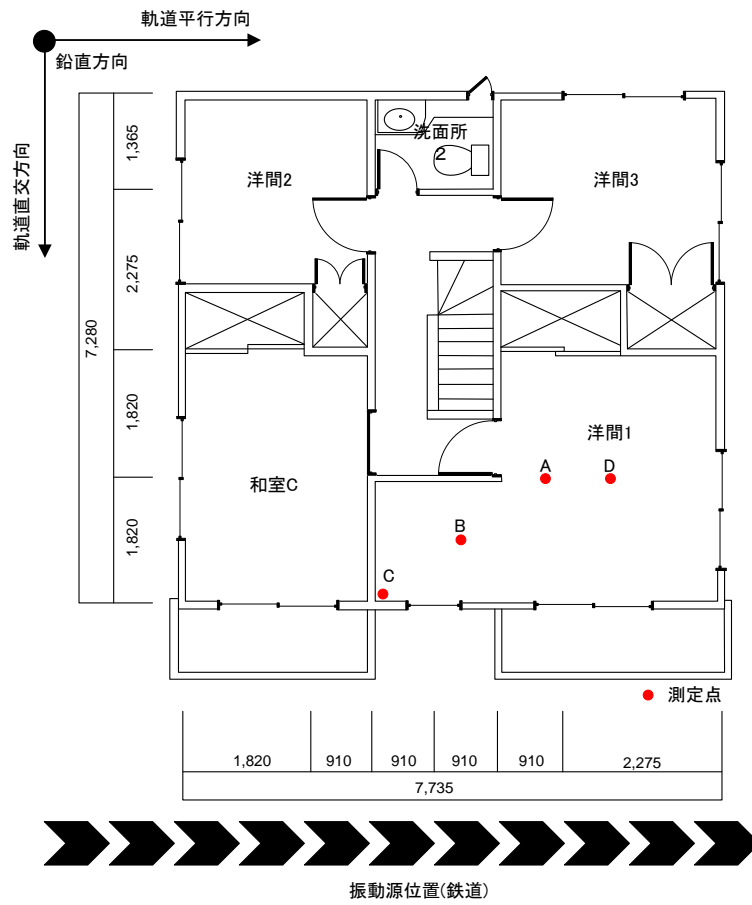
対象建築物の平面図及び測定位置の例(2階平面図)
